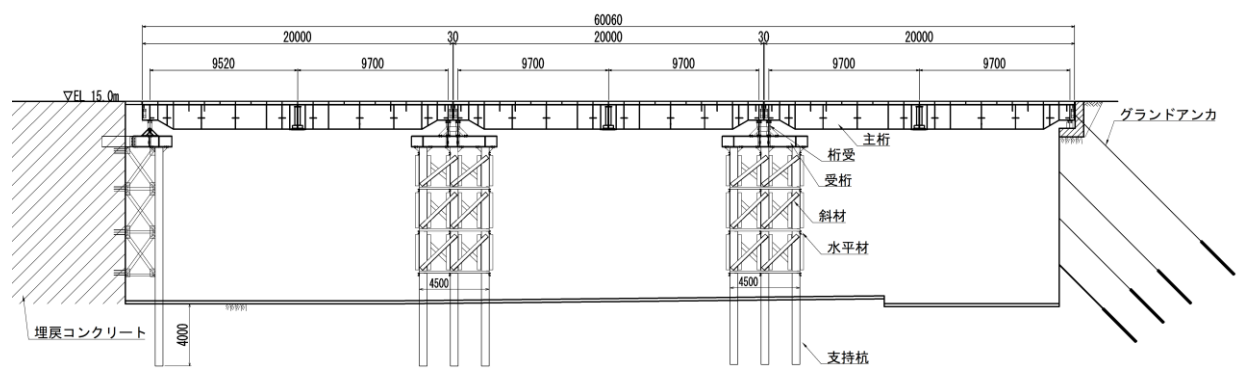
仮設耐震構台 断面図 (A-A 断面)
